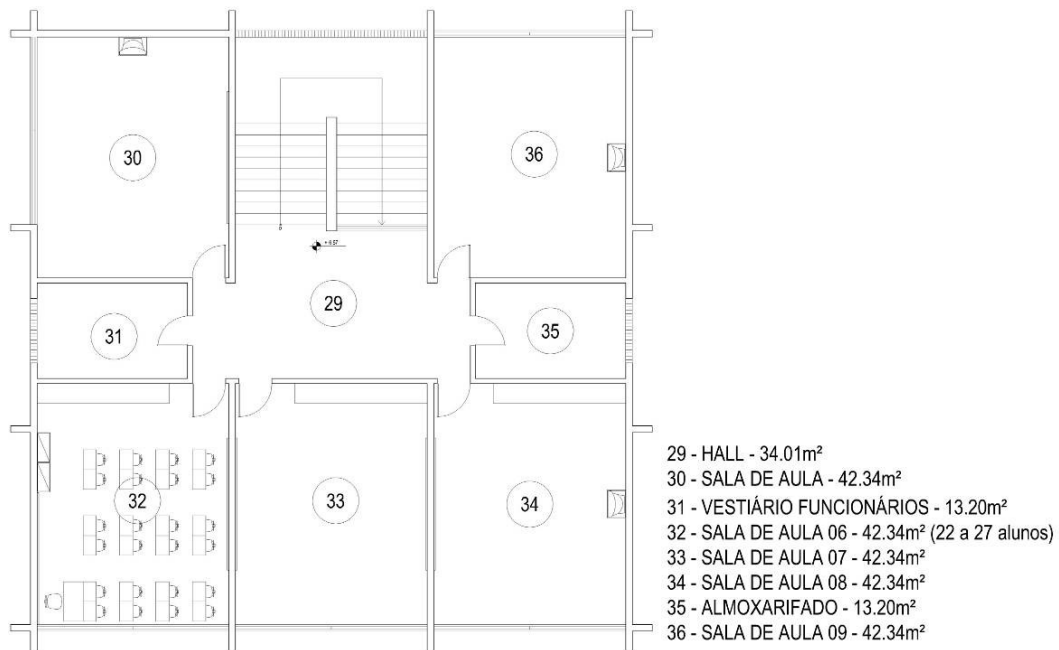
Planta baixa e legenda do 2º pavimento da Escola Albert Schweitzer.
